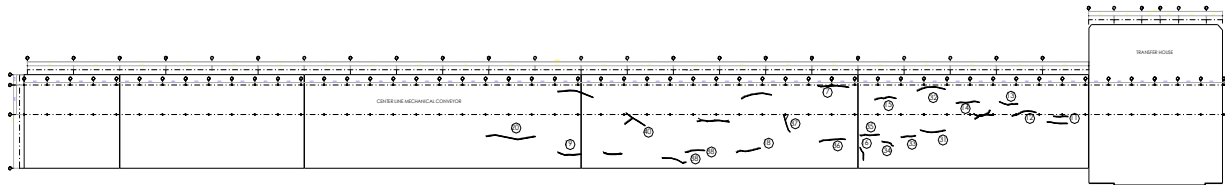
Selimut beton pancang baja mengalami keretakan
